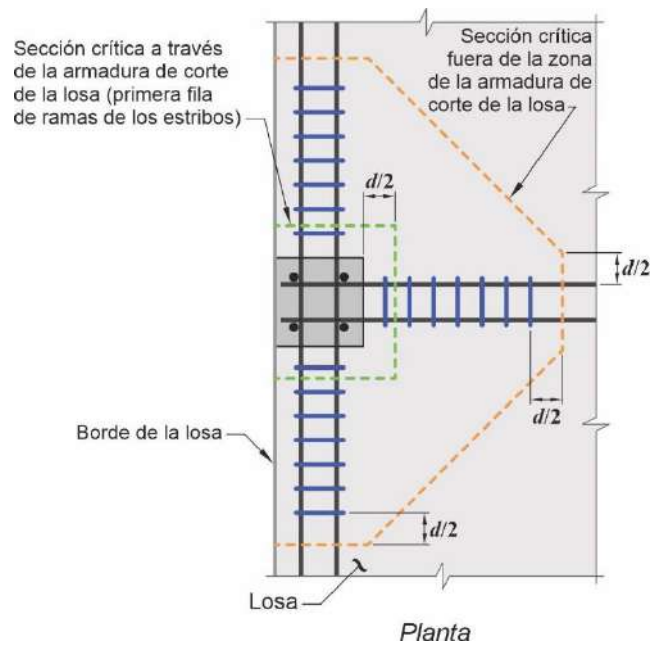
Secciones críticas para corte en dos direcciones en losas con armadura de corte en columnas de borde
